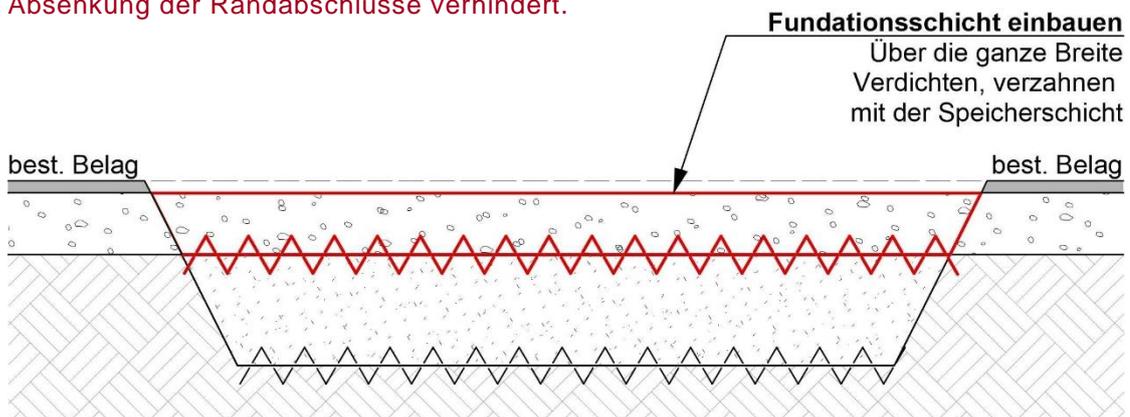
Fundationsschicht einbauen, Quelle: Stadtgrün Bern
